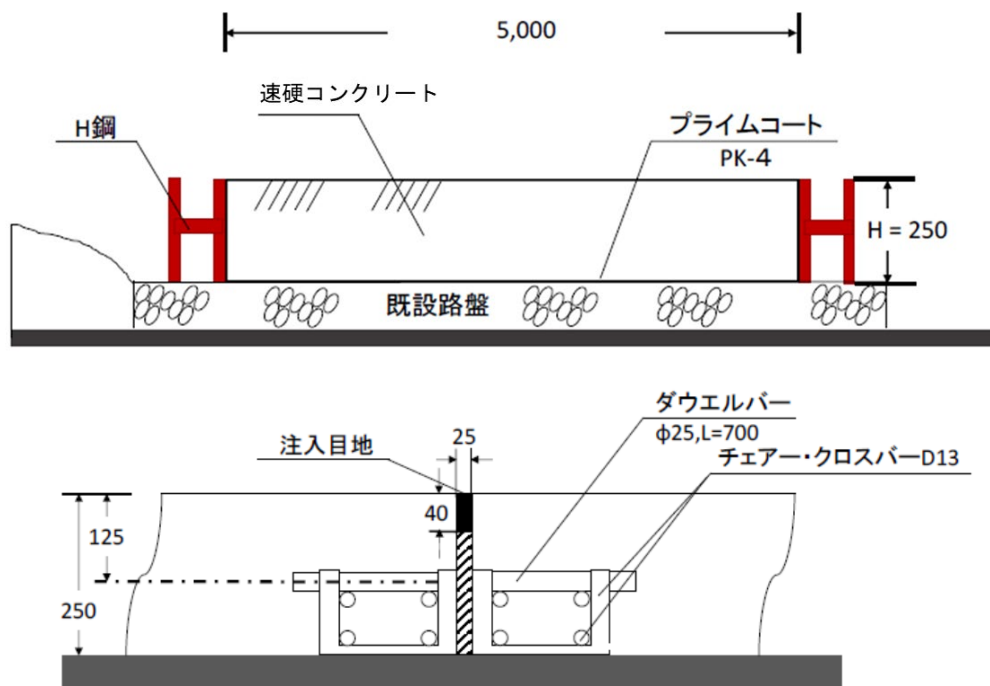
大規模措置技術の施工断面（上：横断面，下：目地部縦断面）
